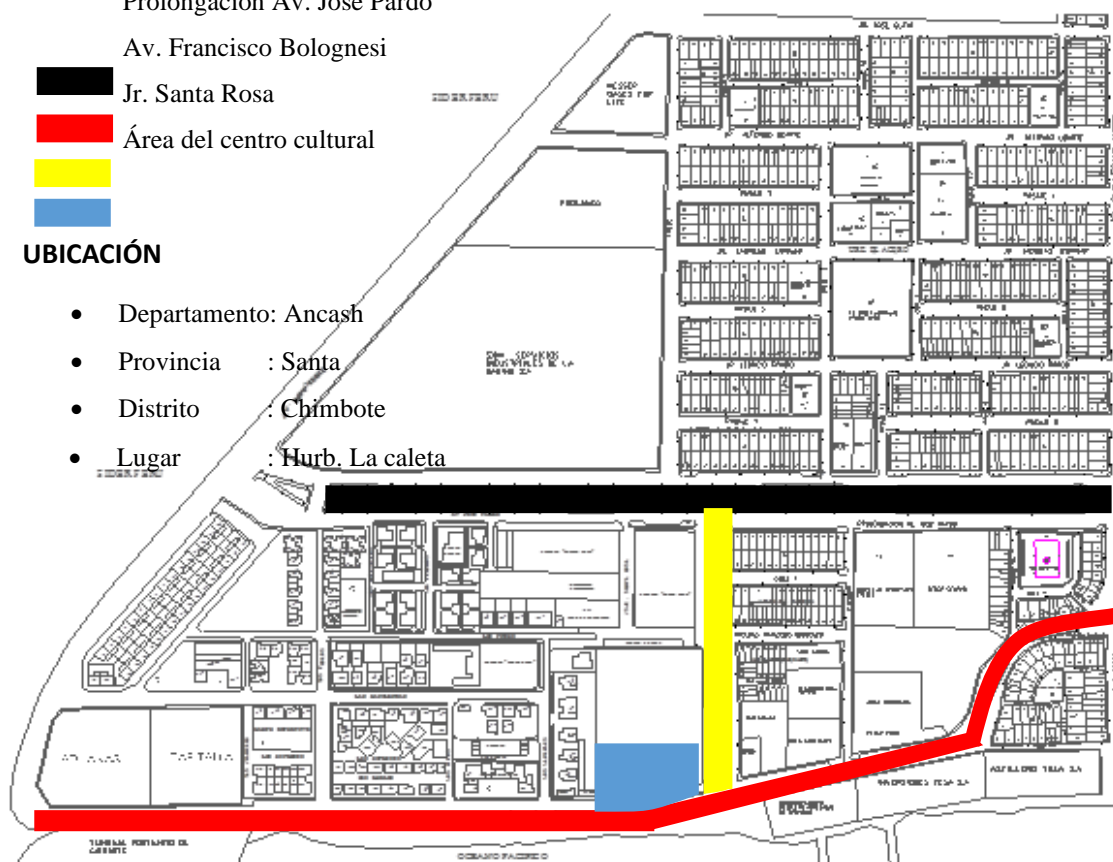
Plano Del Distrito de Chimbote, señalando las principales avenidas y el lugar de intervención. Fuente: Elaboración Propia.
